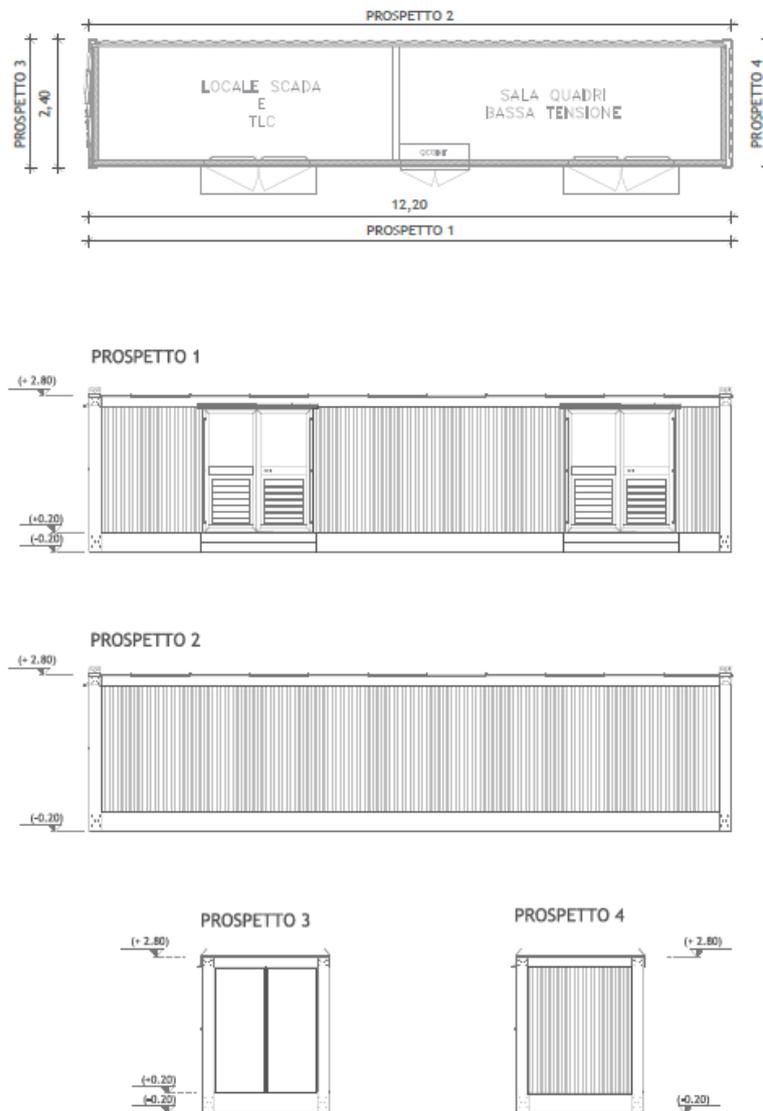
Pianta e prospetti dell'Edificio BT + SCADA e TLC
